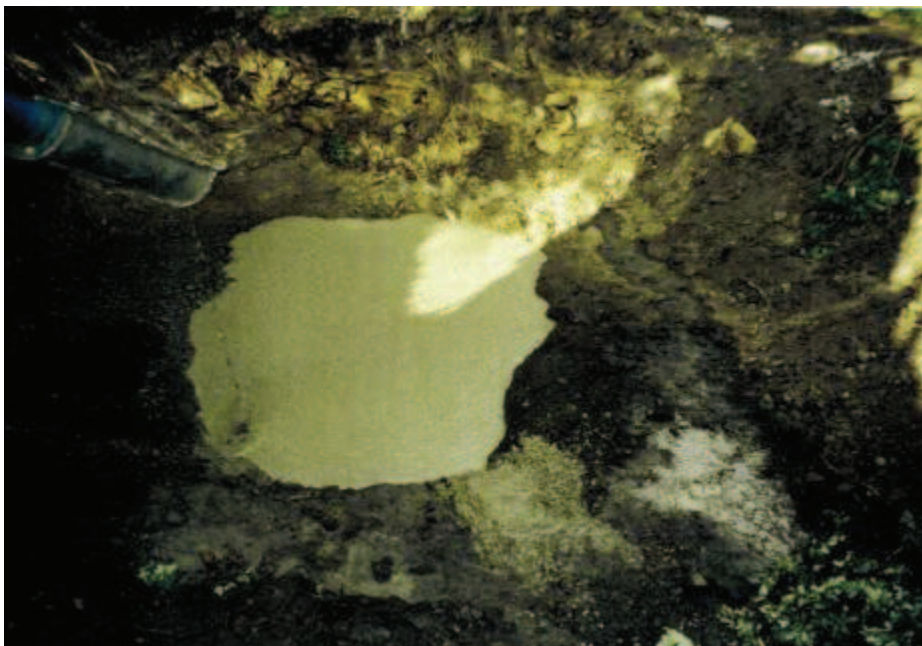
Coulage du bouchon béton au puits de Tinderelle
